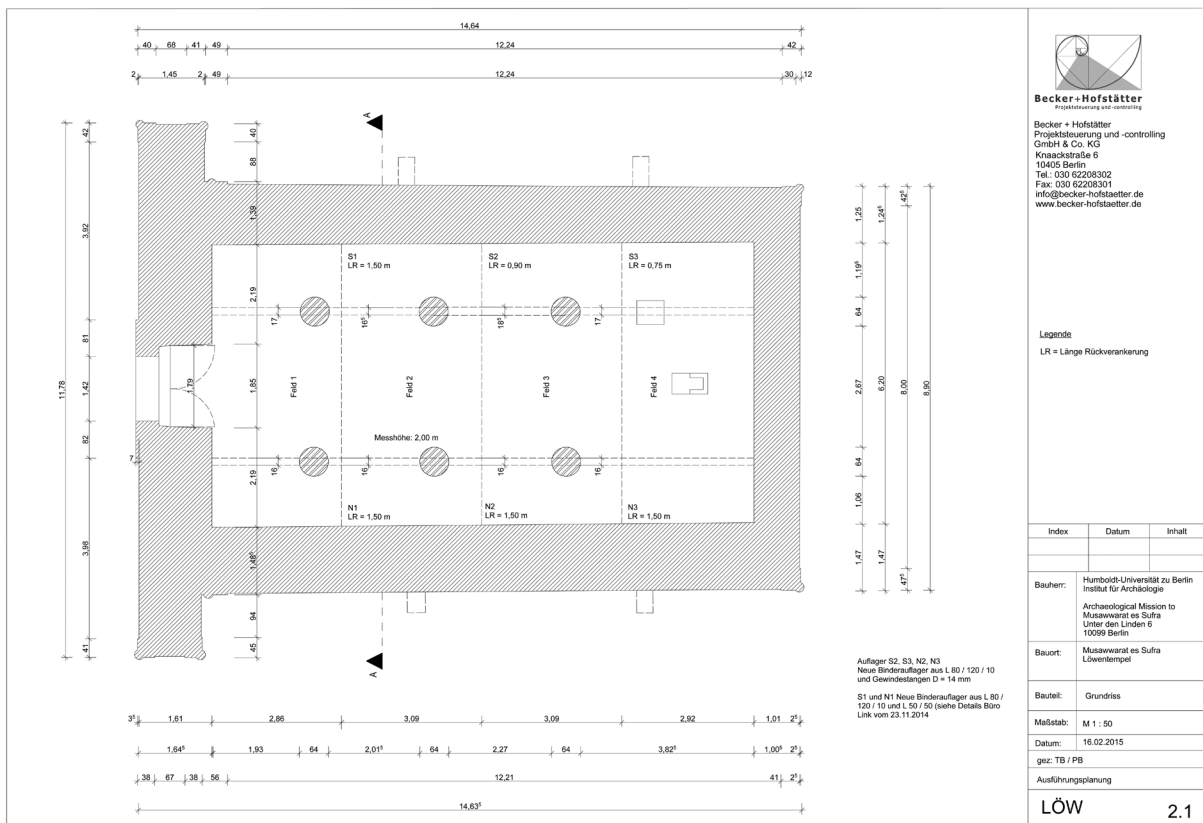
Ausführungsplan Grundriss des Büros Becker + Hofstätter
